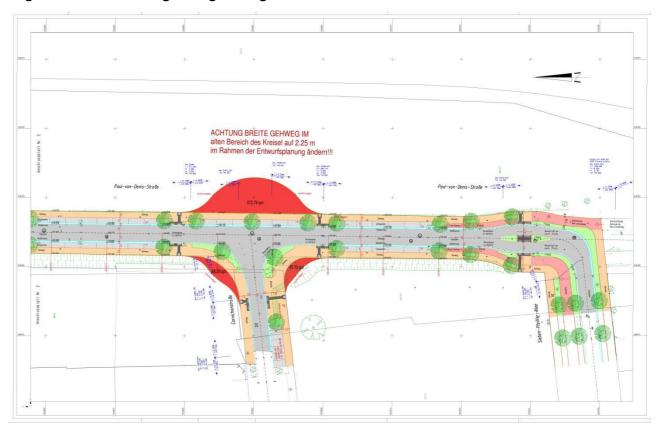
Ausbau der Paul-von-Denis-Straße mit Darstellung der frei werden Flächen (Quelle: Stadt Landau in der Pfalz)
